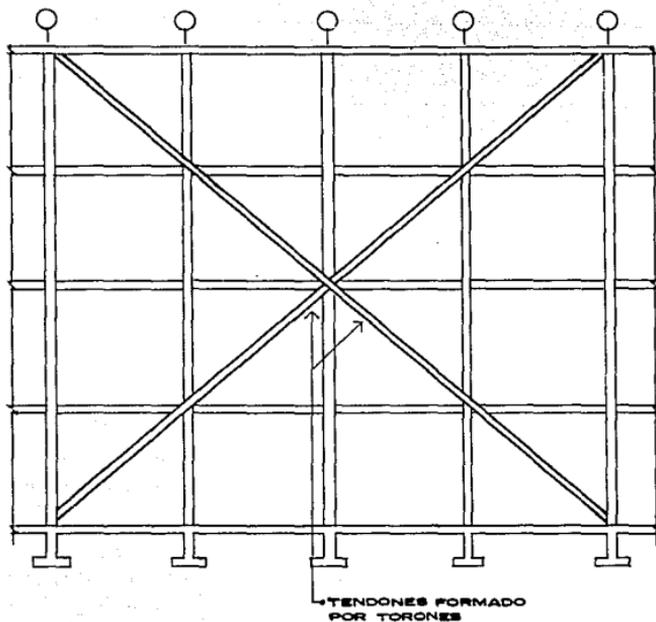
POSTENSADO A BASE DE CABLES
